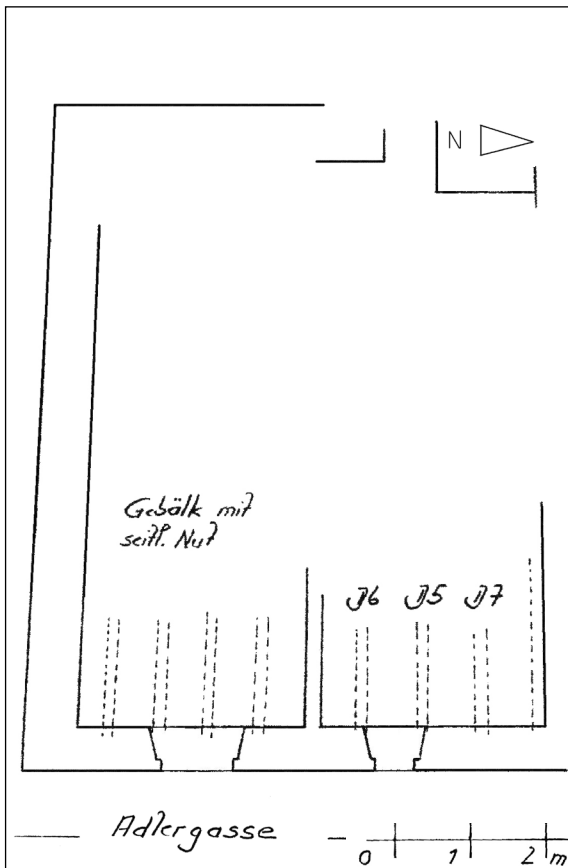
Adlergasse 4, Grundriss 1. Obergeschoss, Ausschnitt.
